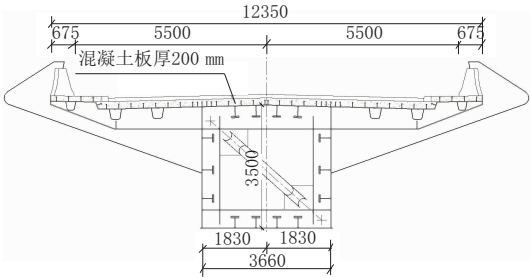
德国某公交车站跨铁路桥标准横断面图(单位:mm)
